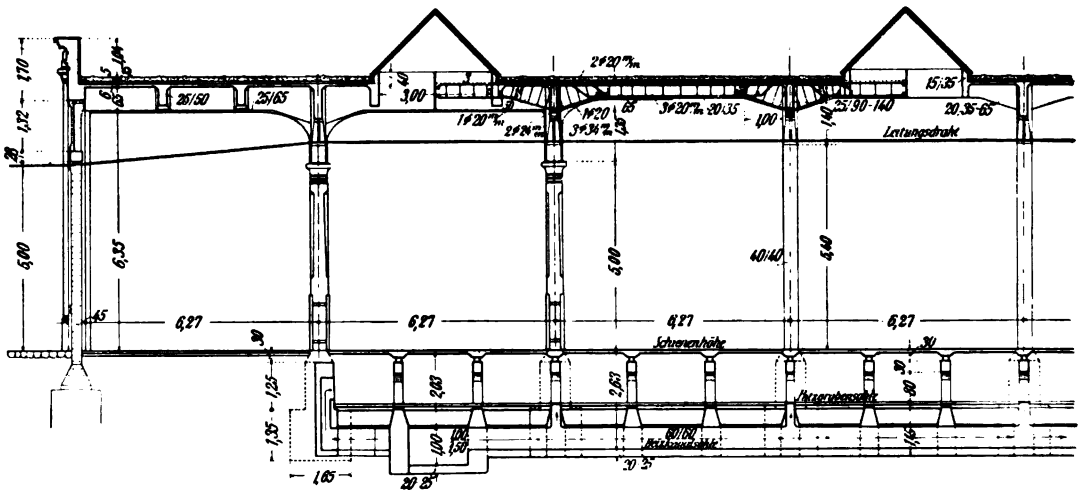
Längenschnitt der Wagenhalle (zu Abb. 125).
